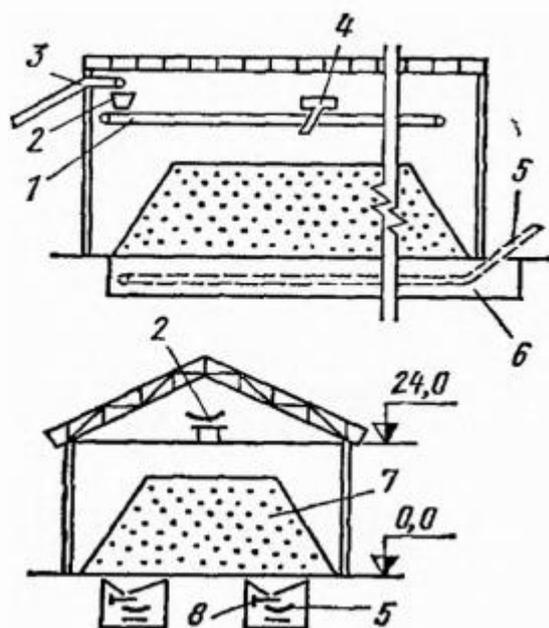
Продольный разрез и план бескранового шихтового отделения с хранением материалов в штабелях
